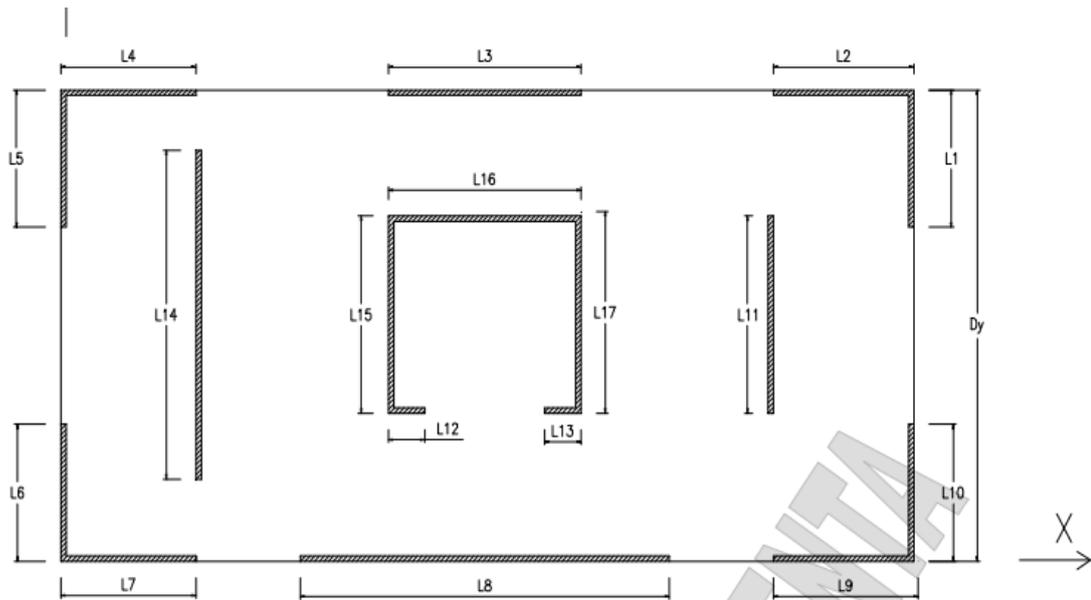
Sistema de muros ortogonales (x,y) Estructura Sistema 2. Fuente: Análisis y diseño sísmico de estructuras (R-001).
